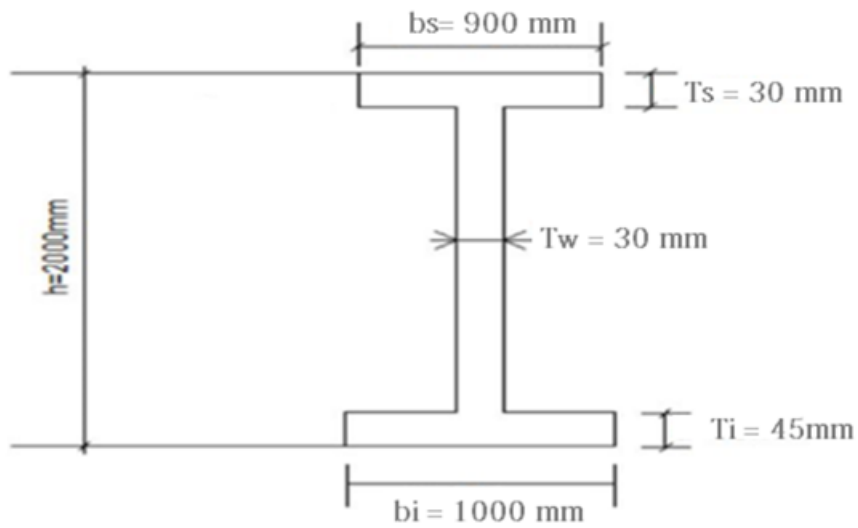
Caractéristiques des poutres principales (PRS) du pont
